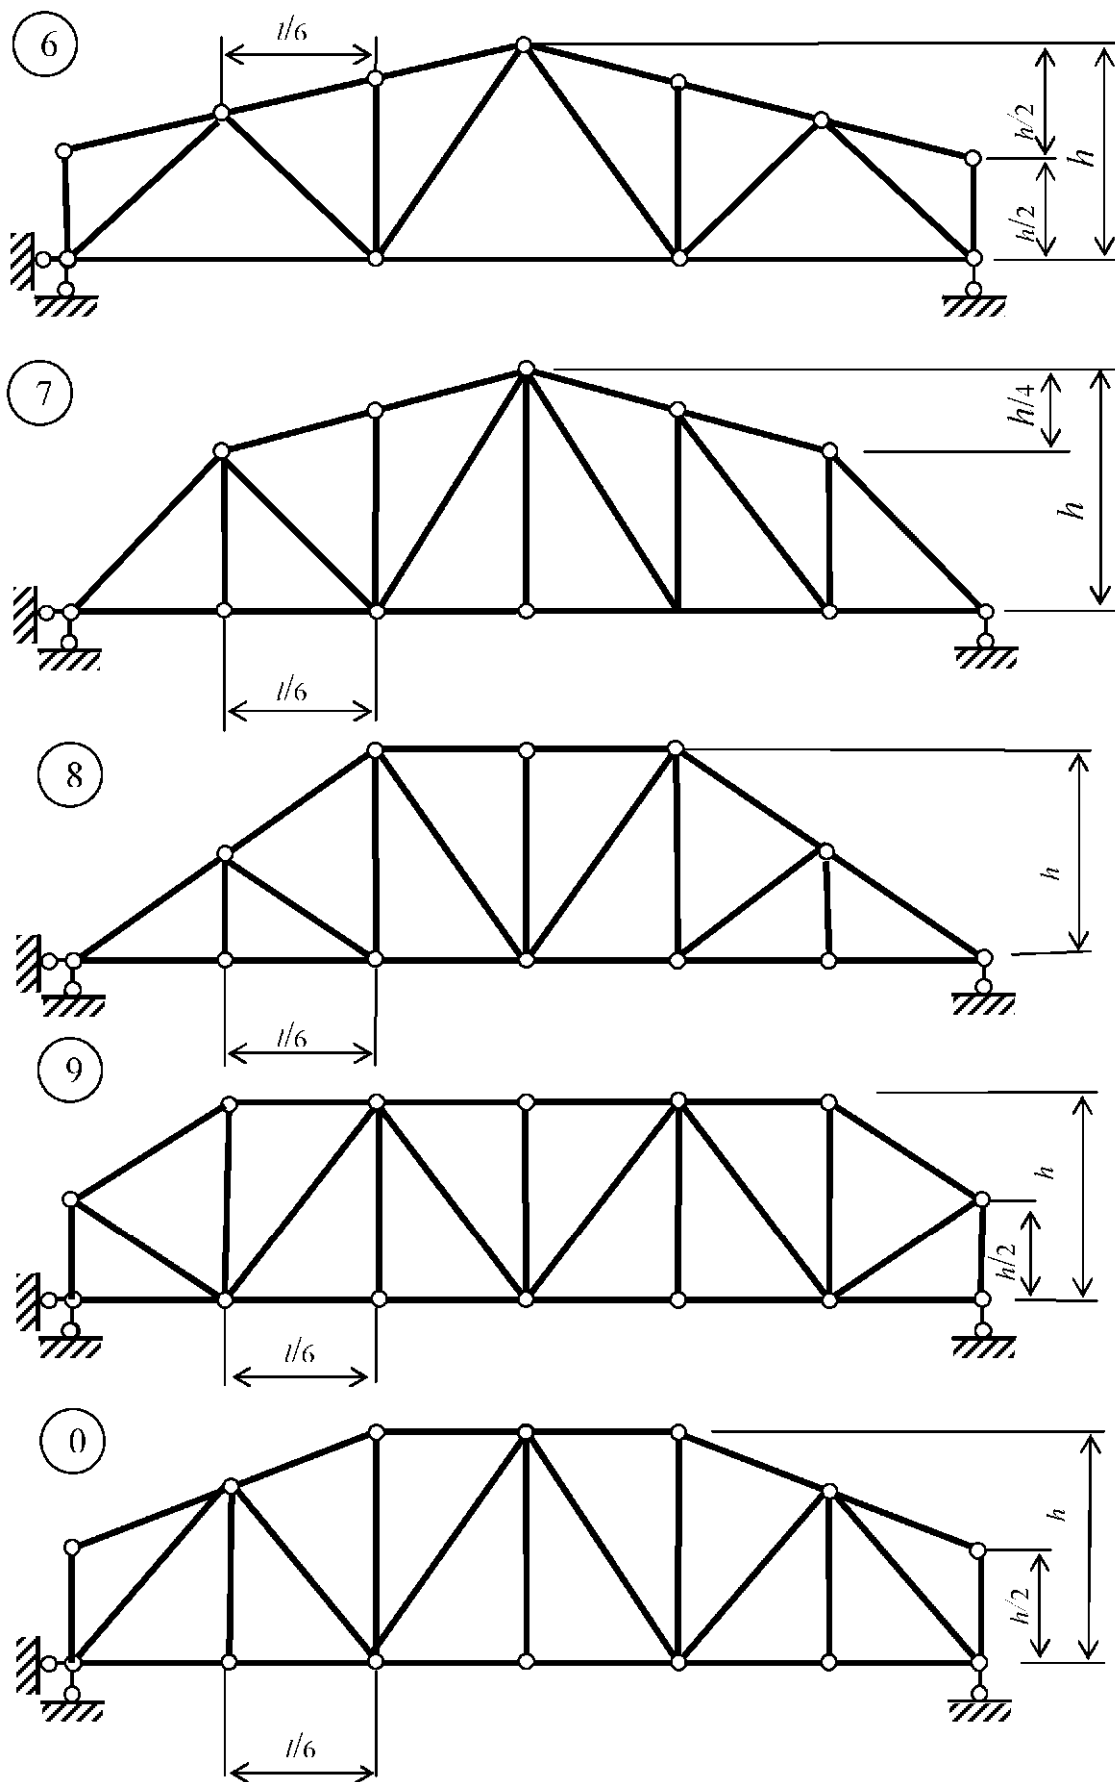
(окончание). Расчетные схемы 6-0 простых ферм
